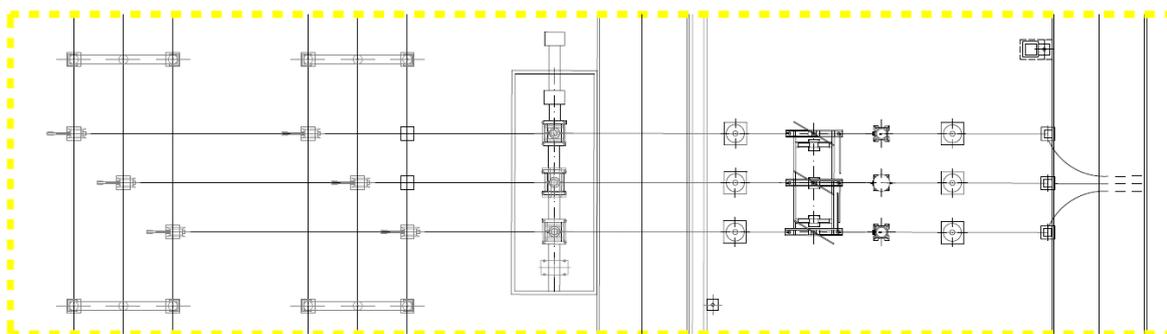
Pianta stallo AT in Stazione Elettrica RTN "Brindisi Sud"
